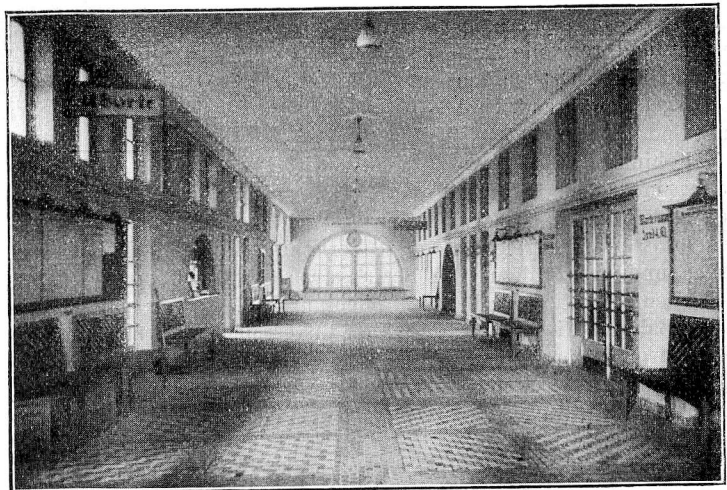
Schalterhalle des Betriebshauptgebäudes in Bad Tölz.
